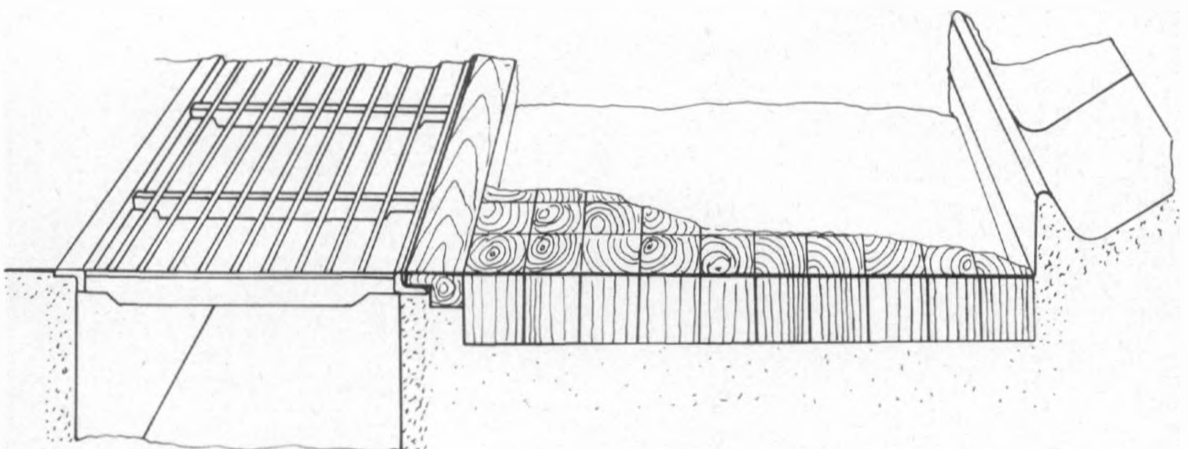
Rost mit Liegefläche planeben, Pflasterabschluß Holzbalken, Rostabschluß Winkelisen
